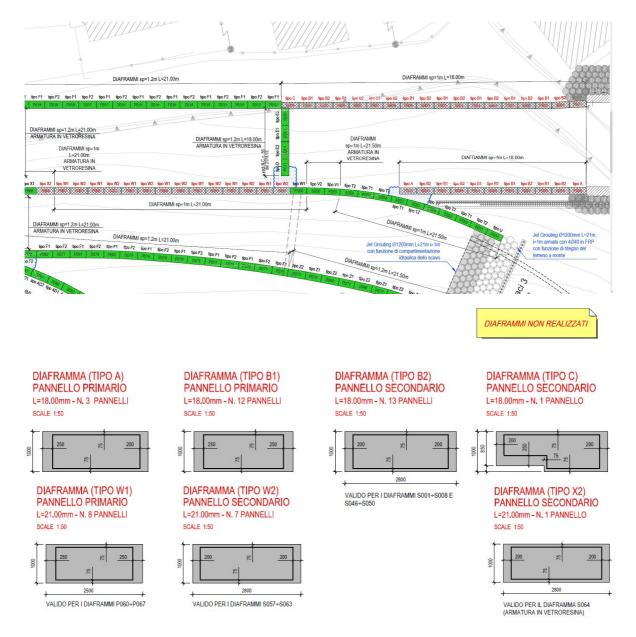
Galleria artificiale Fornaci II – Pannelli dei diaframmi non realizzati (Da As-Built)
